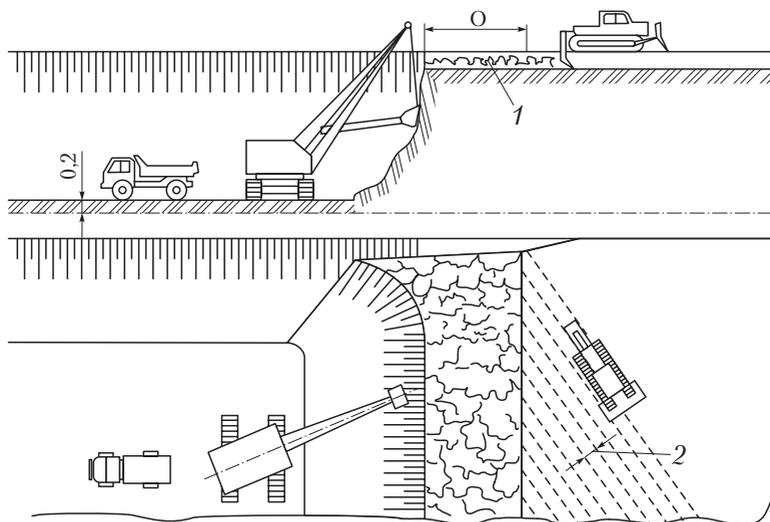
Схема разработки грунта экскаватором в выемке в зимних условиях:
